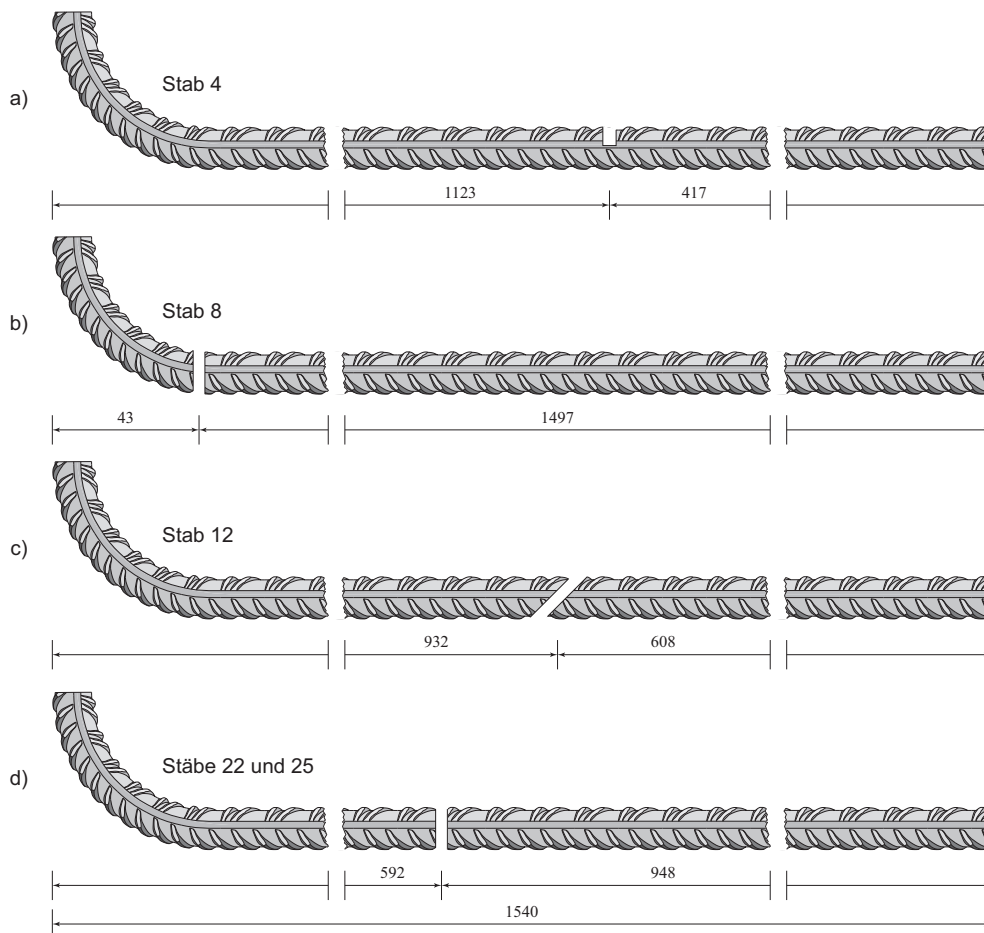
Bewehrungsstab (a) mit eingearbeiteter Nut; (b) mit Bruch direkt an der Abbiegung; (c) mit zur Längsachse schräggestellten Bruchflächen; (d) mit senkrecht zur Längsachse stehenden Bruchflächen. Abmessungen in mm.
